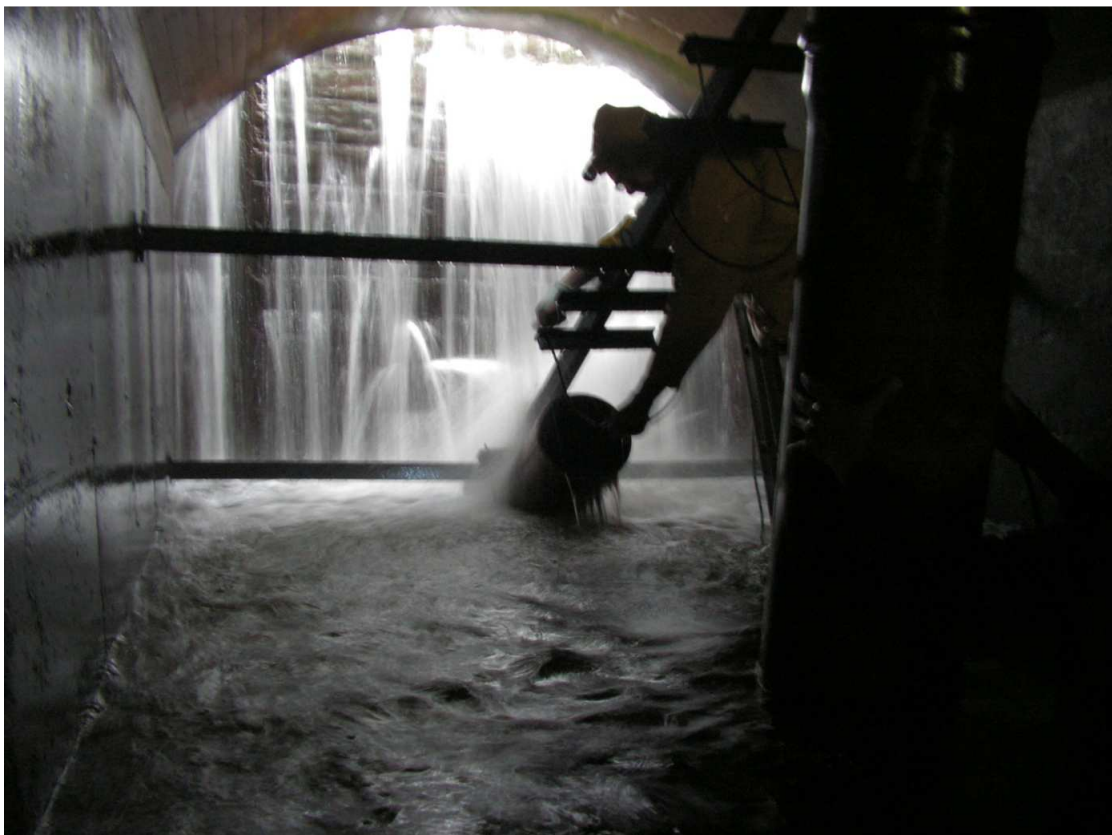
Installation des unteren Rohres des bodennahen Bypasssystems
